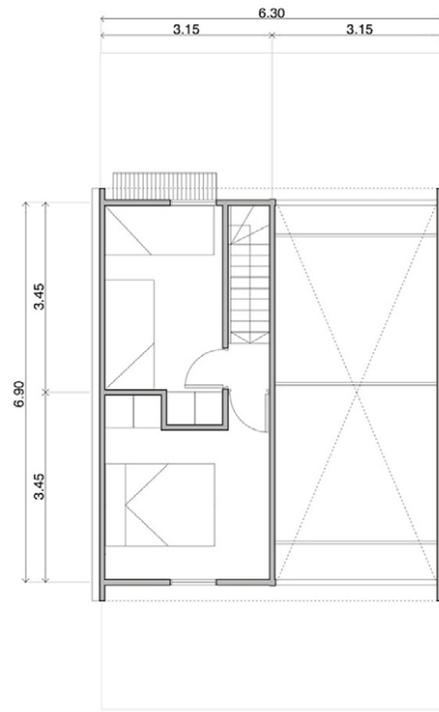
Planta Alta INICIAL Villa Verde.
